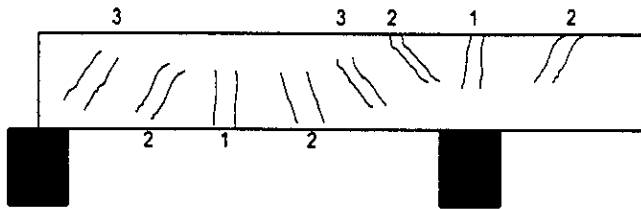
Grietas en un elemento de concreto reforzado o presforzado:
